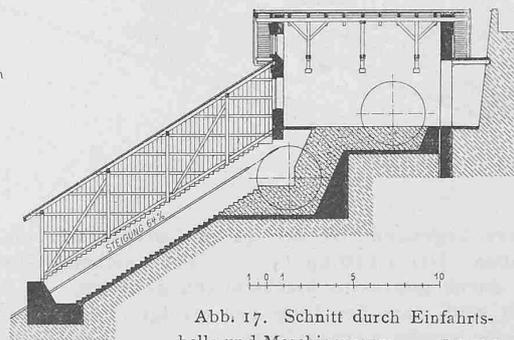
Schnitt durch Einfahrthalle und Maschinenraum. — 1 : 400.
